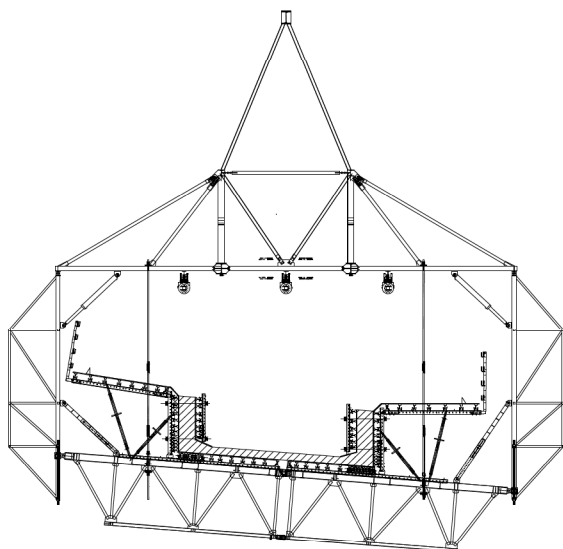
Autocimbra sobre tablero para vanos de 62 m de luz: sección transversal en posición de hormigonado
